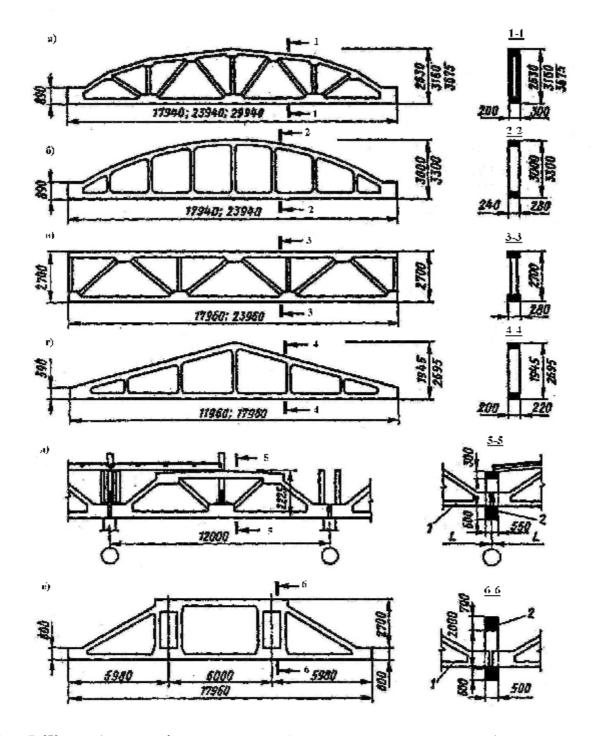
Железобетонные фермы покрытий (а – стропильная сегментная; б – стропильная сегментная, арочная бескаркасная; в – стропильная сегментная с параллельными поясами; д – подстропильная длиной 12 м; е – подстропильная длиной 18 м): 1 – стропильная ферма; 2 – подстропильная ферма
